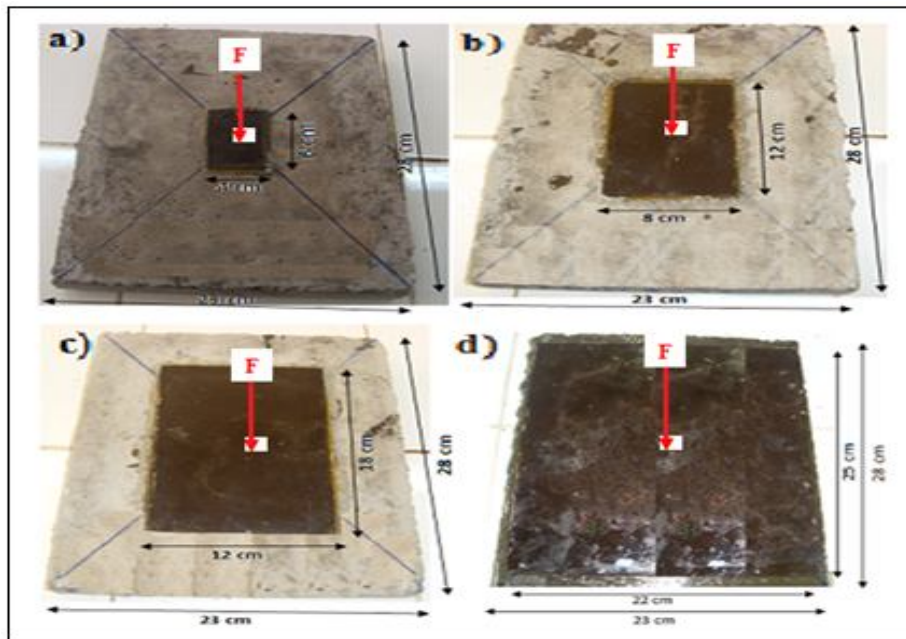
Mise en point du dispositif d'essai de poinçonnement.
